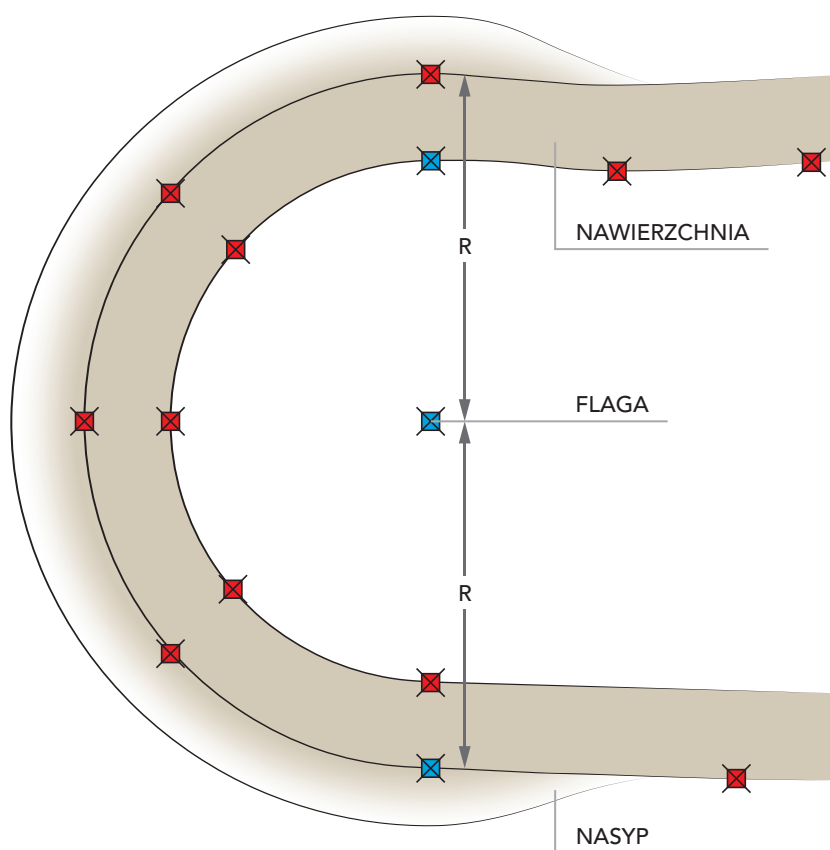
Schemat zakrętu z wyprofilowaną platformą
